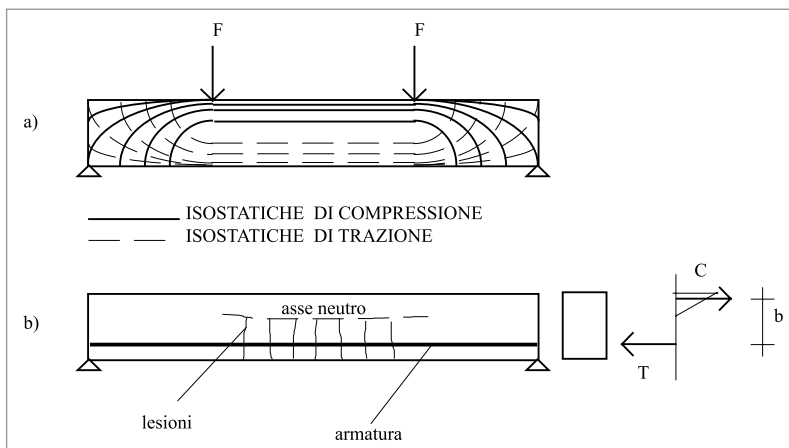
Schema fessurativo e posizione dell'asse neutro in travi in calcestruzzo armato soggette a flessione
